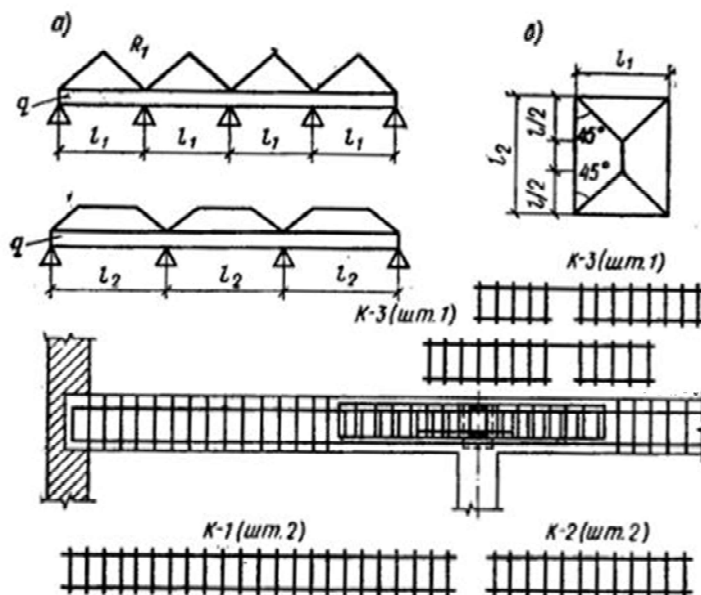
Расчетные схемы и армирование балок ребристых перекрытий с плитами опертыми по контуру
